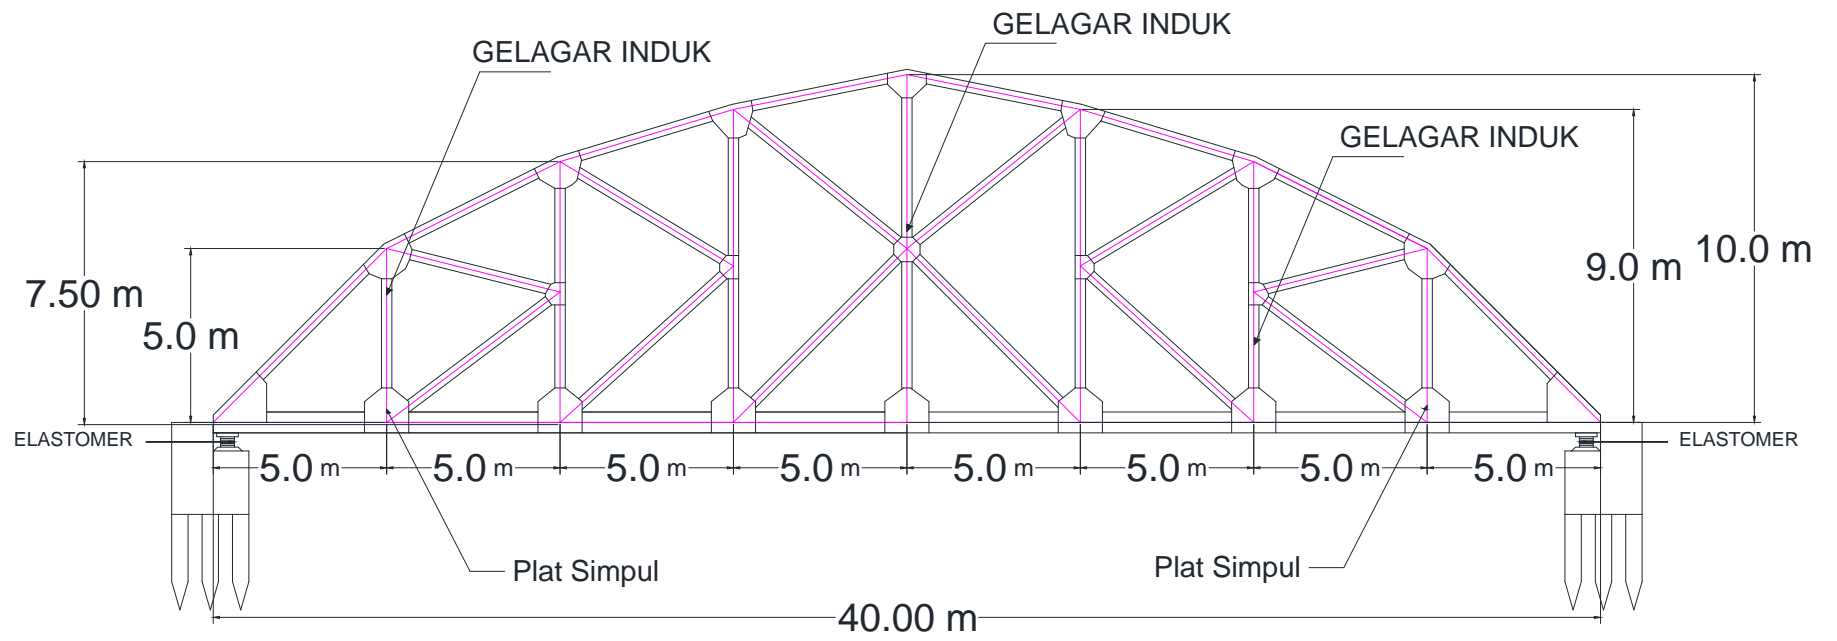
potongan memanjang jembatan existing tipe V - Truss
